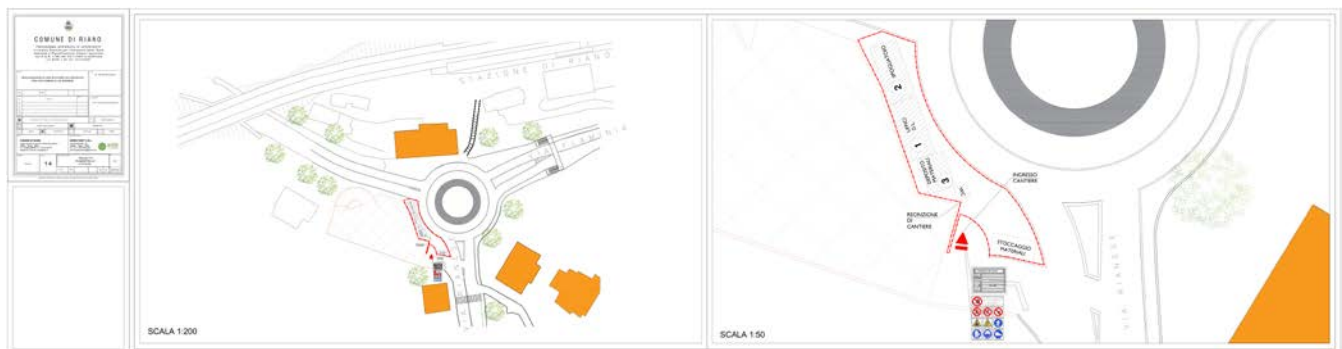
Planimetria di cantiere C14: accessi, recinzioni, depositi, uffici, servizi e stoccaggi.
